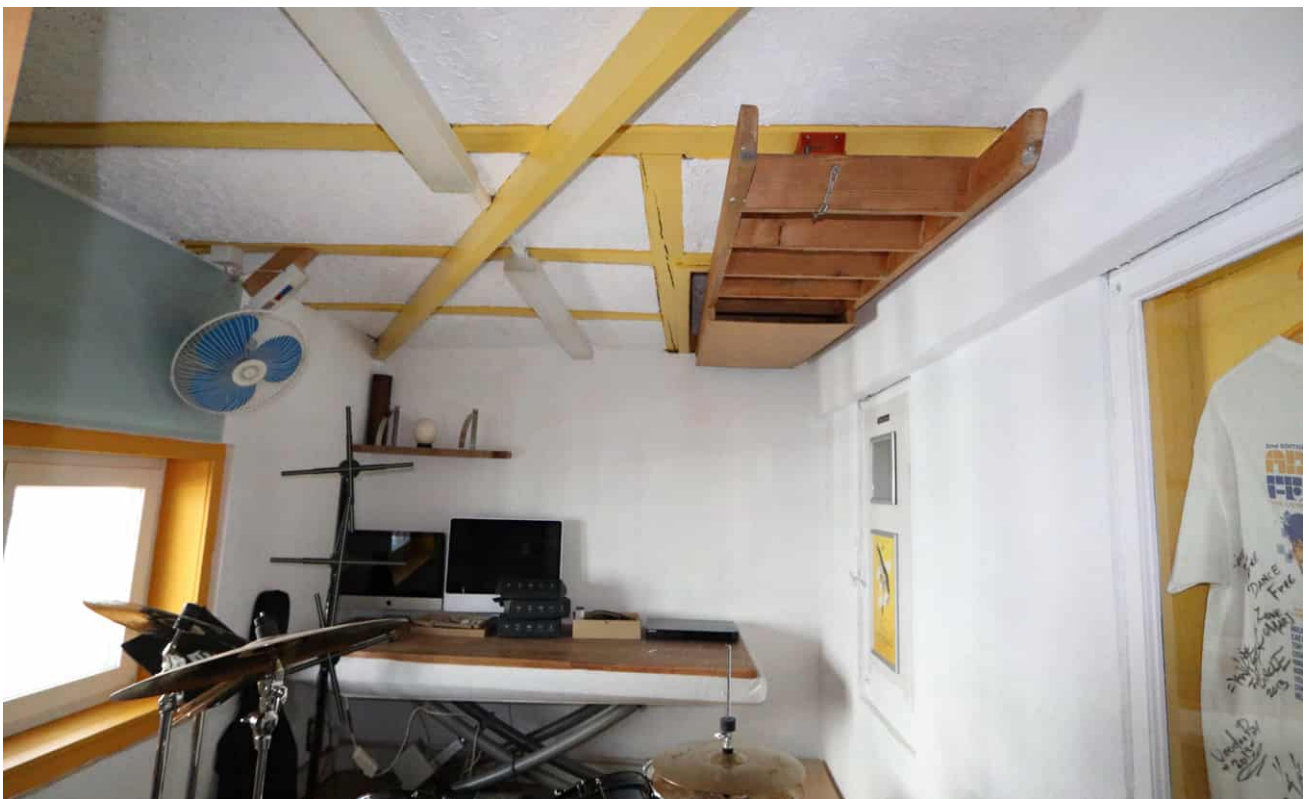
Östlicher Kopfbau, 2. OG, Raum zur Rapperswilerstrasse hin. Rechts Öffnungen zum ehemaligen Dachraum über dem Bühnenhaus.
